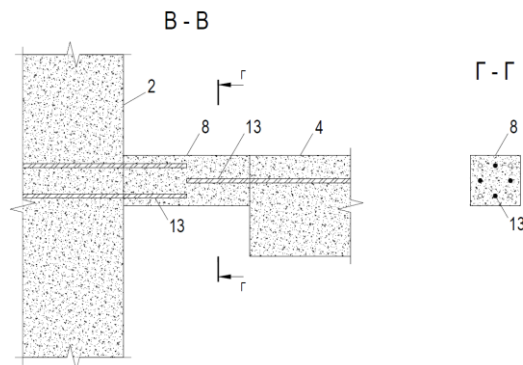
Выключающаяся связь в виде бетонной балки
